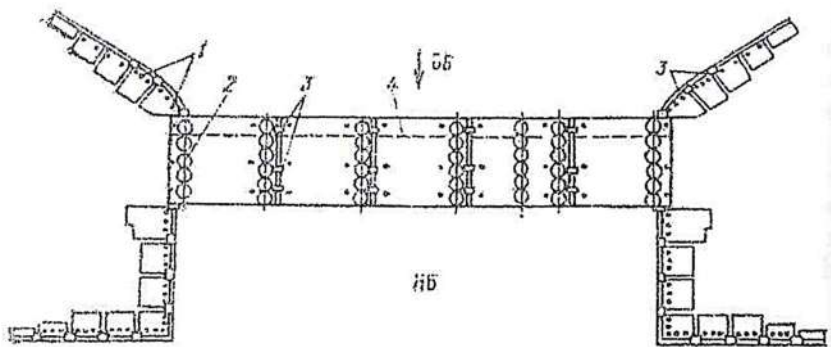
Схема расположения КИА на секциях и береговых устоях водопропускного сооружения на нескальном основании:
